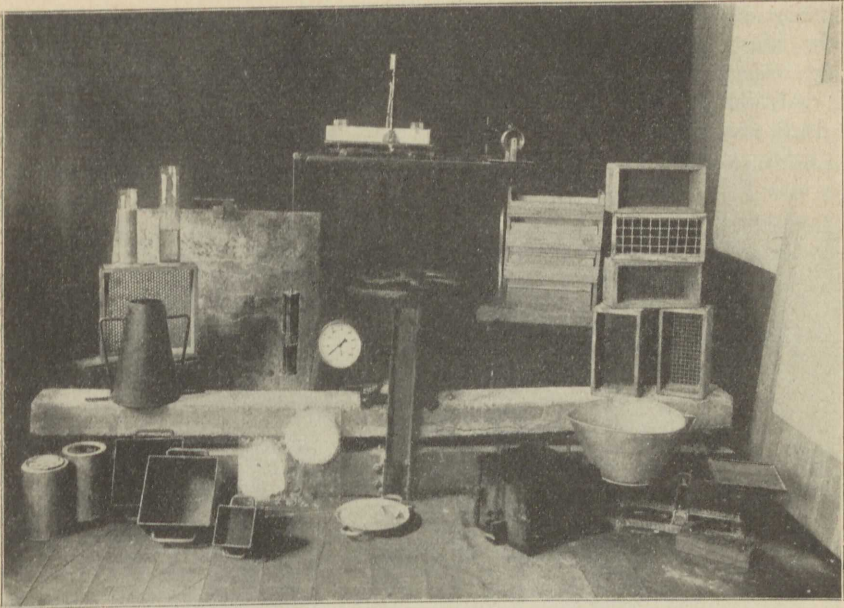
Firma B. Geräte zur Betonuntersuchung.
